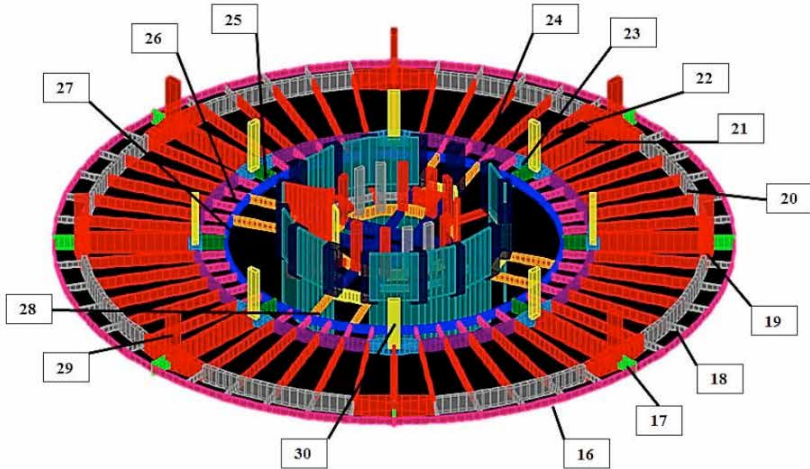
Elementos estruturais do pavimento tipo modelados, bloco A.
